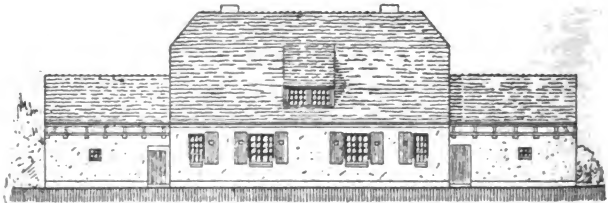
Arbeiterwohnhaus für zwei Familien mit angebauten Ställen, Vorderansicht (Preuß. Landwirtschaftsministerium).
